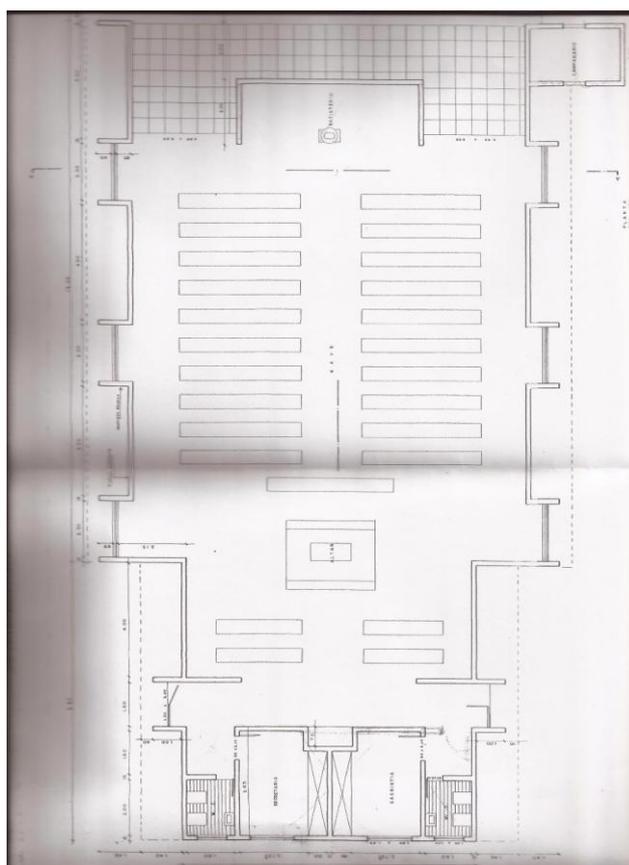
Planta baixa da Igreja de Nossa Senhora da Santíssima Trindade. (Fonte: Cohab)
